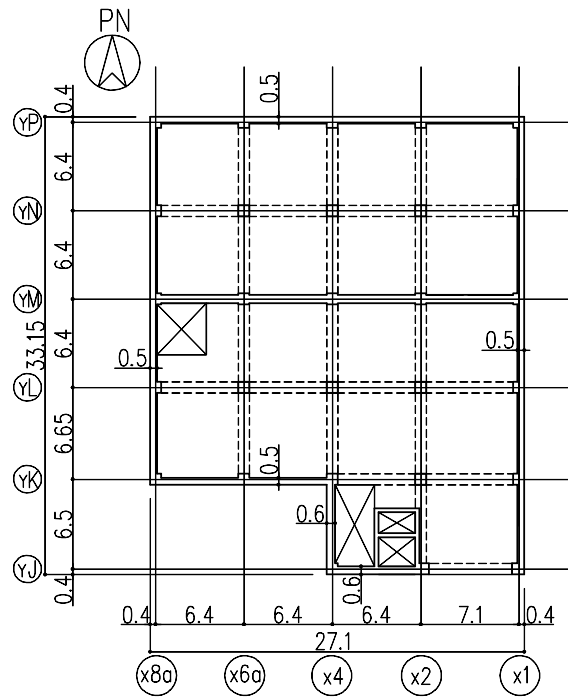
地下1階平面図 (G.L. -4.2) (单位 : m)
